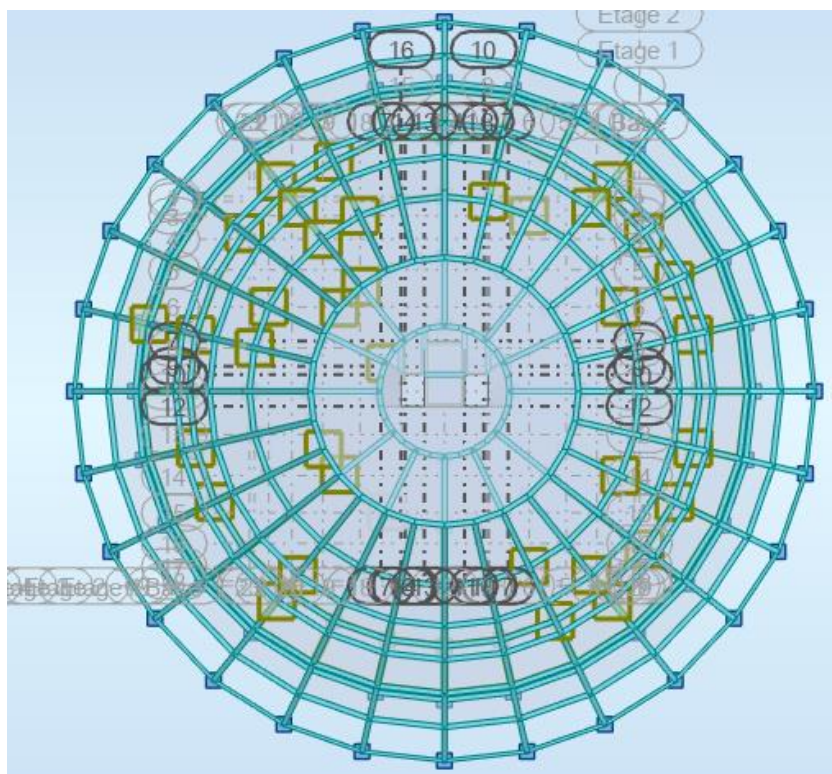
Vue en plan du schéma structural de l'ouvrage [RSAP]
